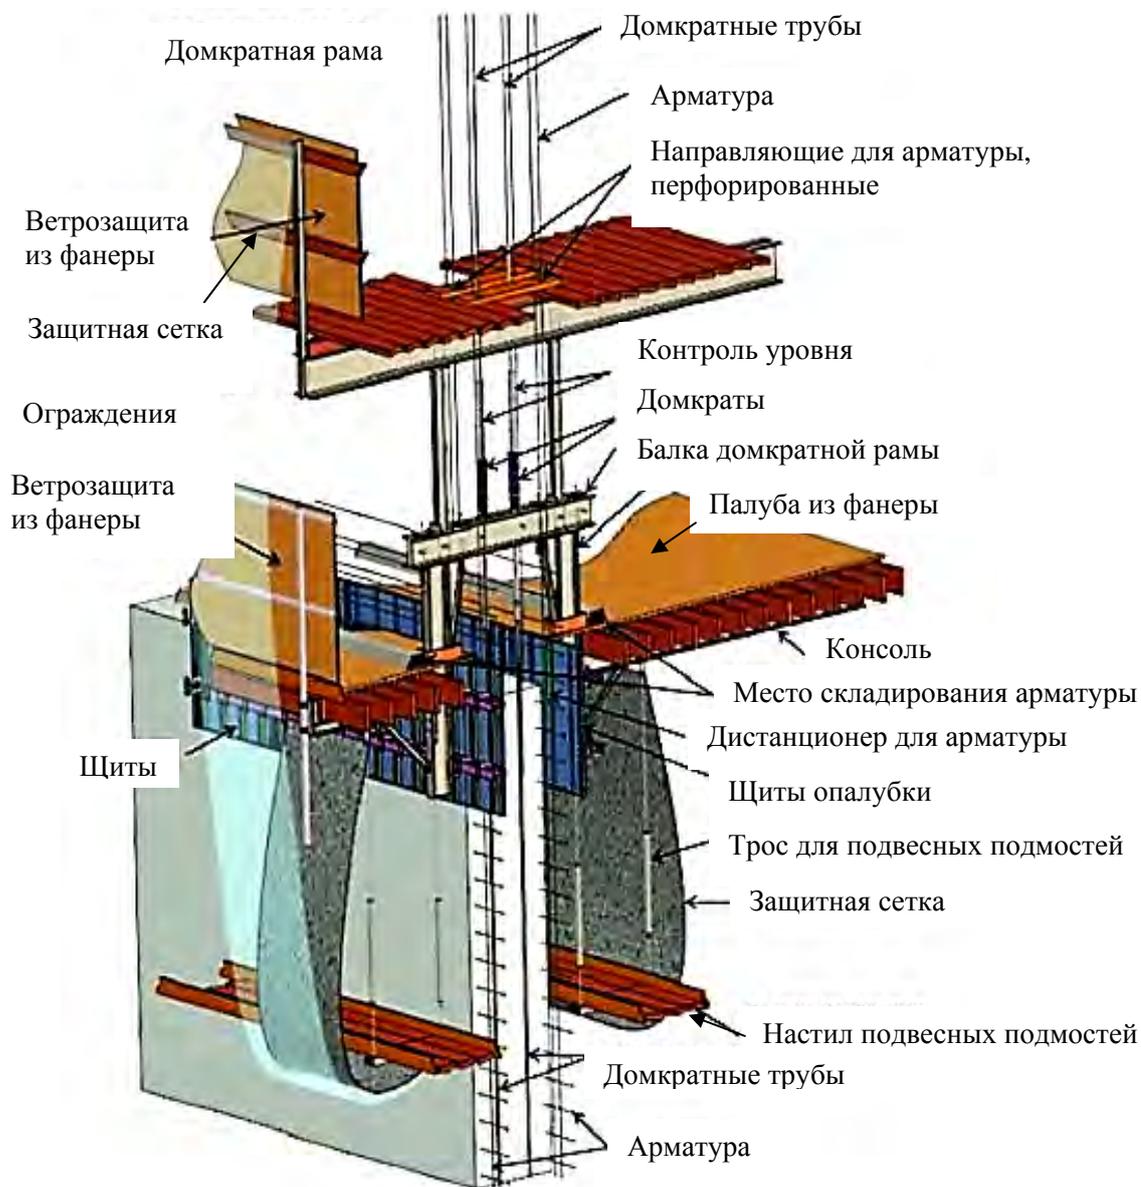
Элементы и конструкция скользящей опалубки [23]
